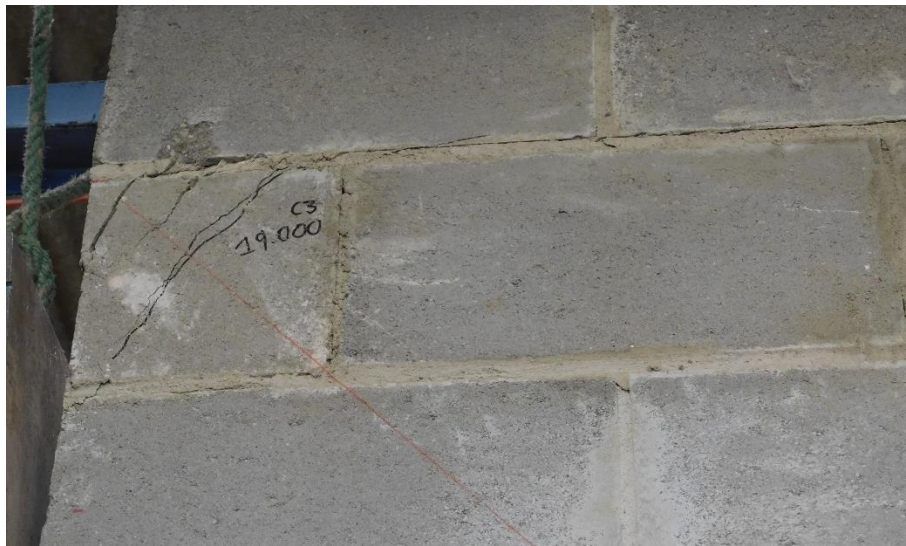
Fisuras en la cara frontal del muro MC-2#4/40
